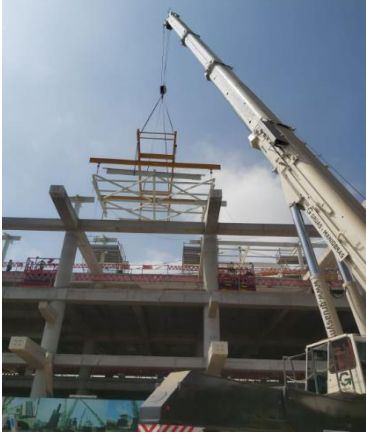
TOPOGRAFIA, ALINEAMIENTO DE VIGAS
